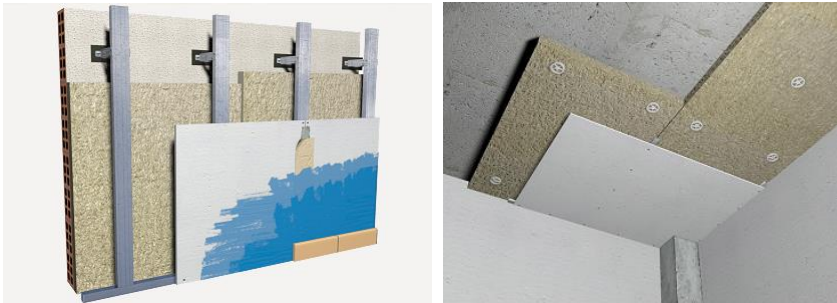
Aislamiento térmico en fachadas y particiones; Imagen 31. Aislamiento térmico en forjado plano e inclinado. Fuente: *Generador de precios
